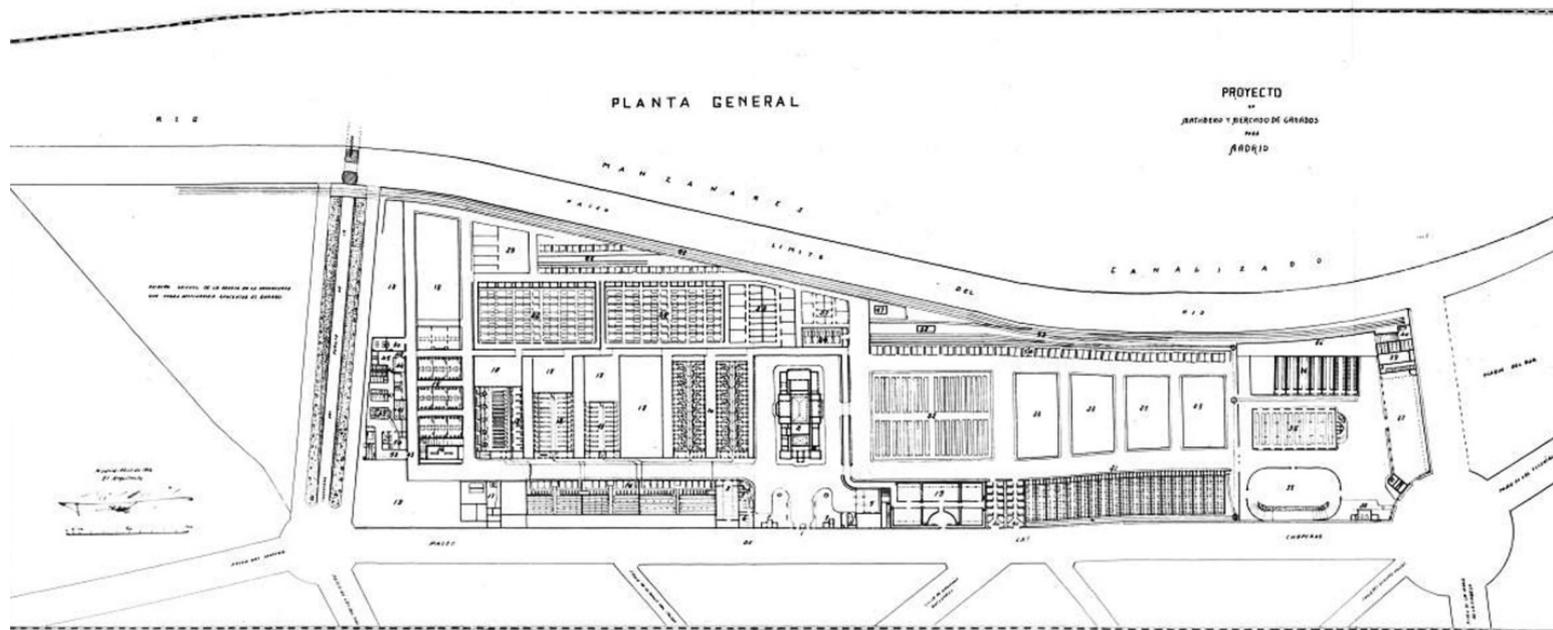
Planta Geral do projeto para o Novo “Matadero y Mercado de Ganados para Madrid, abril de 1914. Ilustração retirada do livro: El Nuevo Matadero y Mercado de Ganado, do arquiteto Luiz Bellido. Fototipia de Hauser y Menet. Disponível em: http://www.memoriademadrid.es/buscador.php?accion=VerFicha&id=26915&num_id=74&num_total=102
